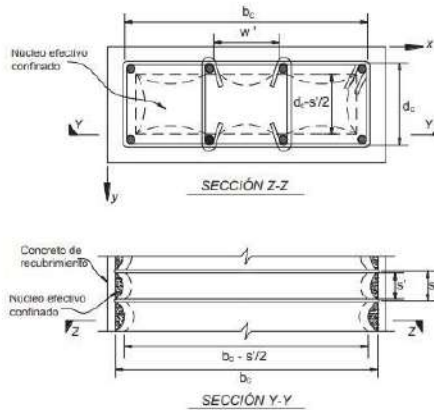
Núcleo confinado efectivo para estribos de refuerzo rectangulares.
